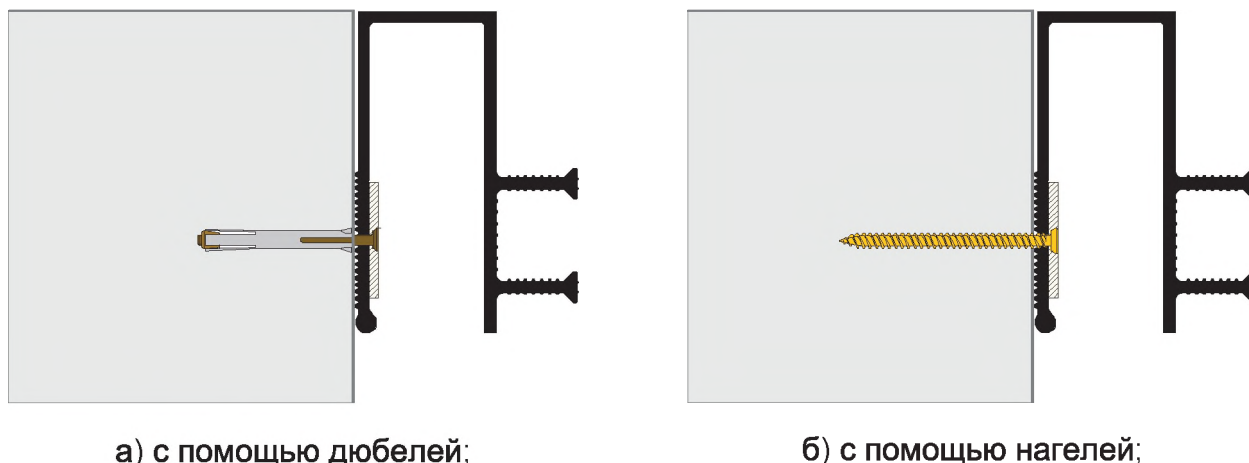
Крепление защитной шпонки тип ДЗС к бетонной конструкции
